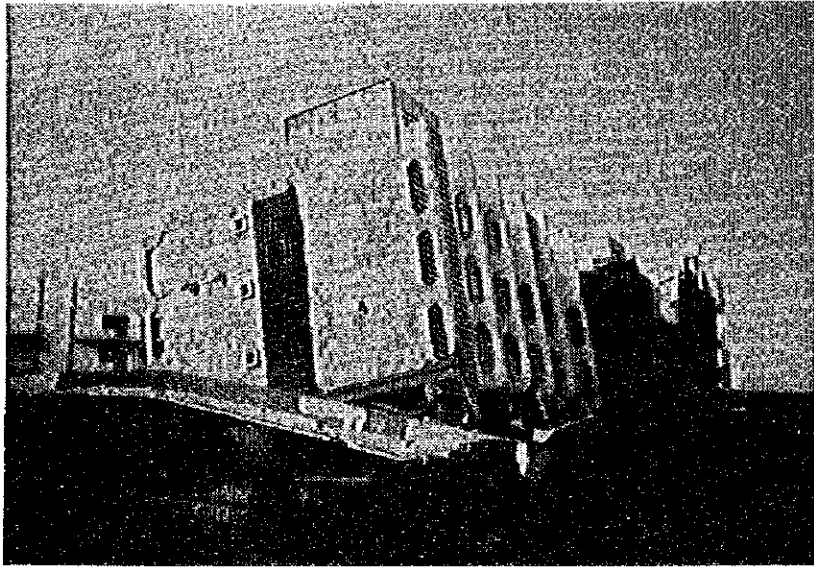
一階にピロティのある建物はピロティ部の破壊により建物全体が傾斜し大破している。
